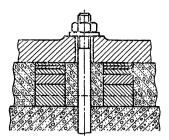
Установка подкладок с двух сторон фундаментного болта
